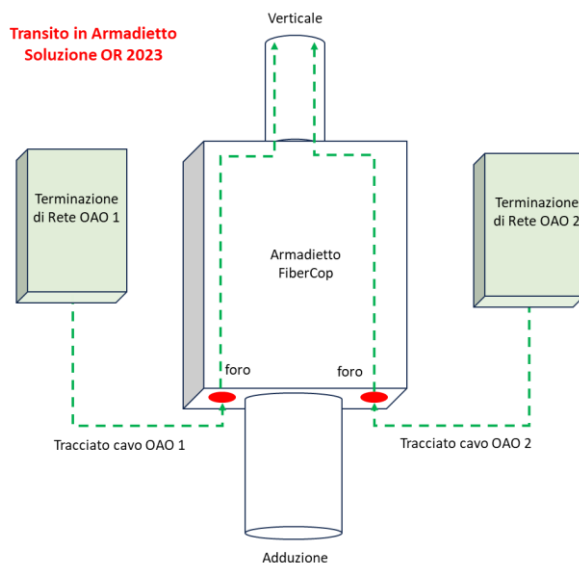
servizio di transito nell'armadietto – soluzione OR 2023
